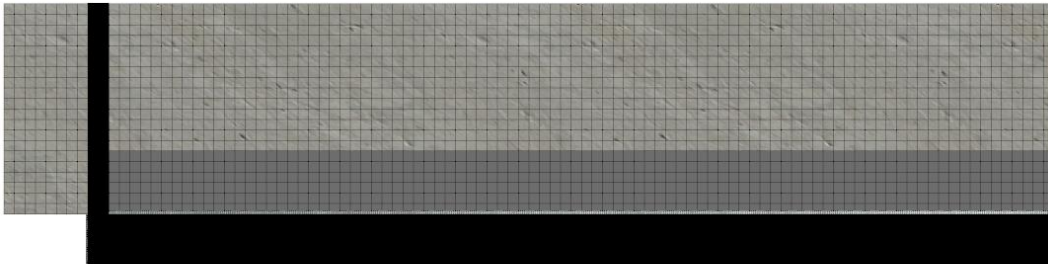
Vista de la configuración de la viga y la sección anexada (negro) y del mortero fibroreforzado (gris claro).
